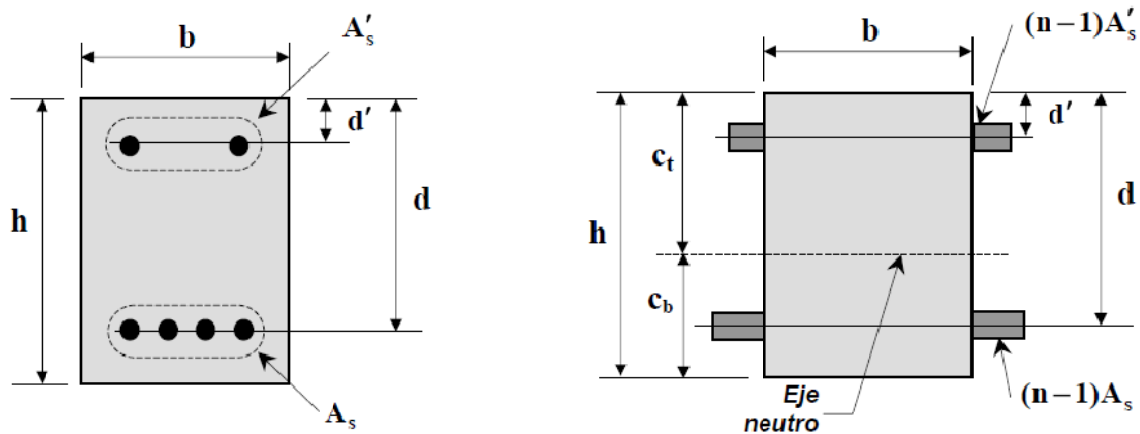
Sección de viga de rigidez no fisurada.
